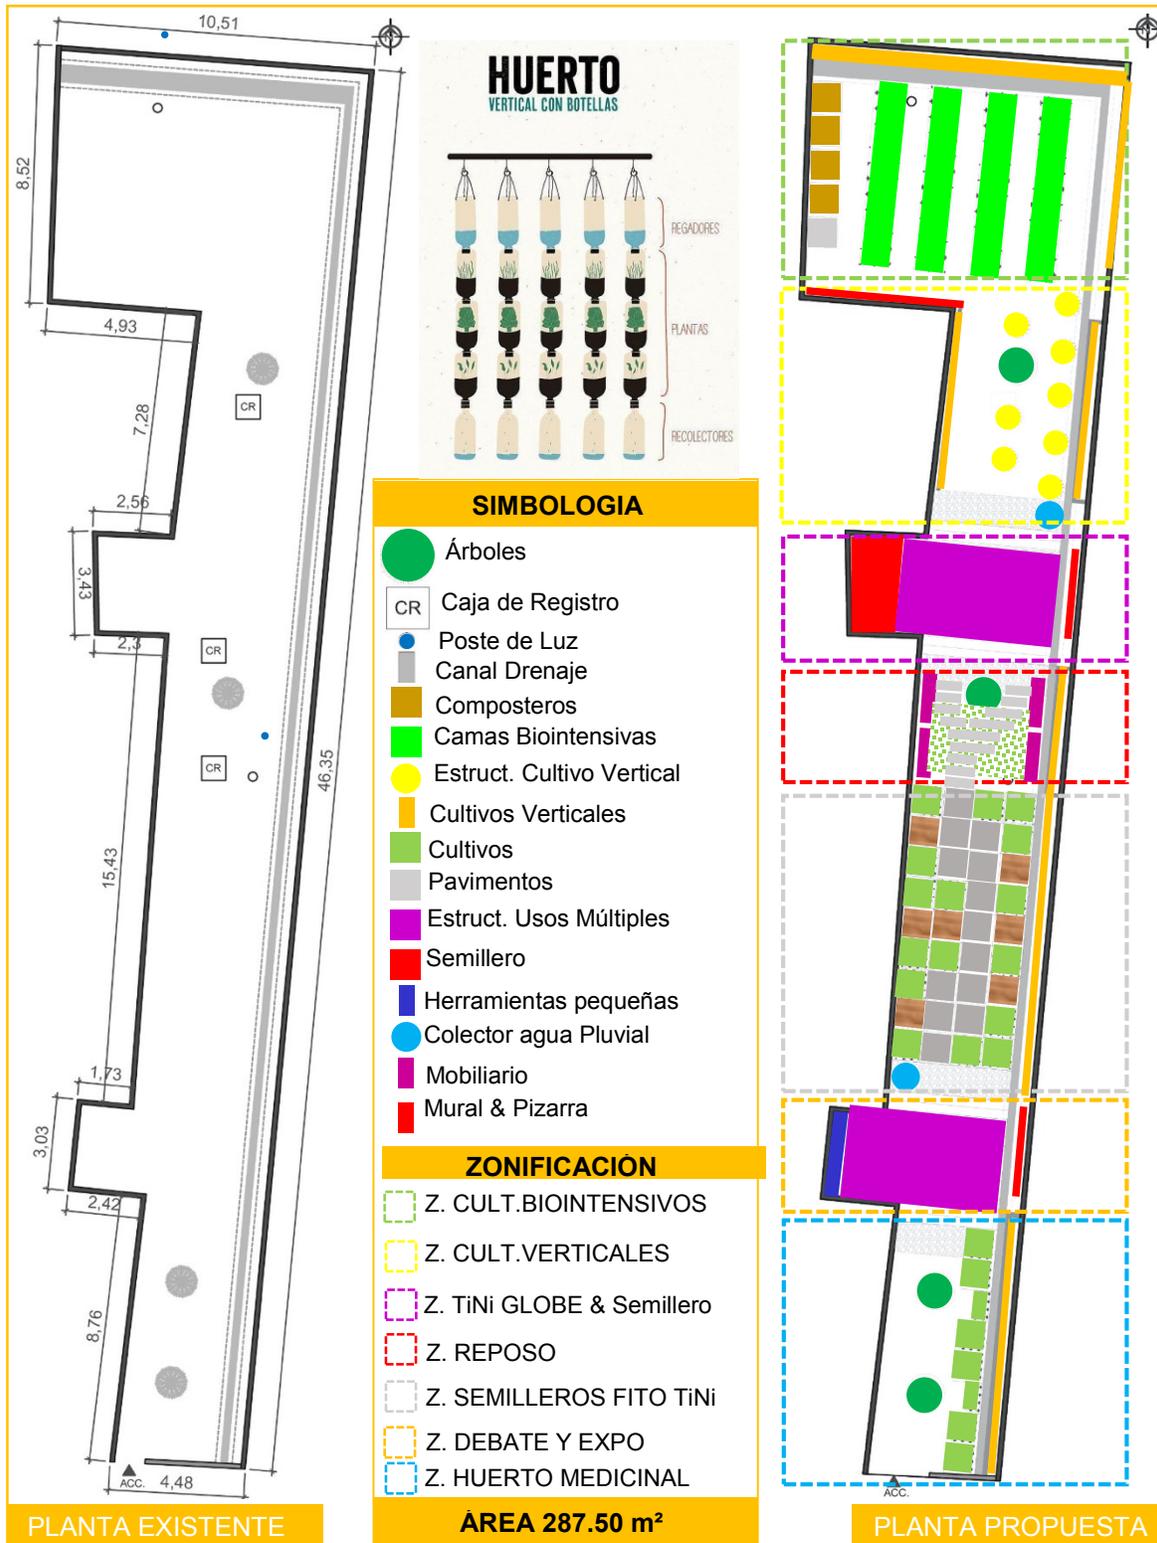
Planta Existente & Planta Propuesta Aula Verde. Fuente: Autor. Programa: Autocad. Huerto Vertical Botellas Pinterest
